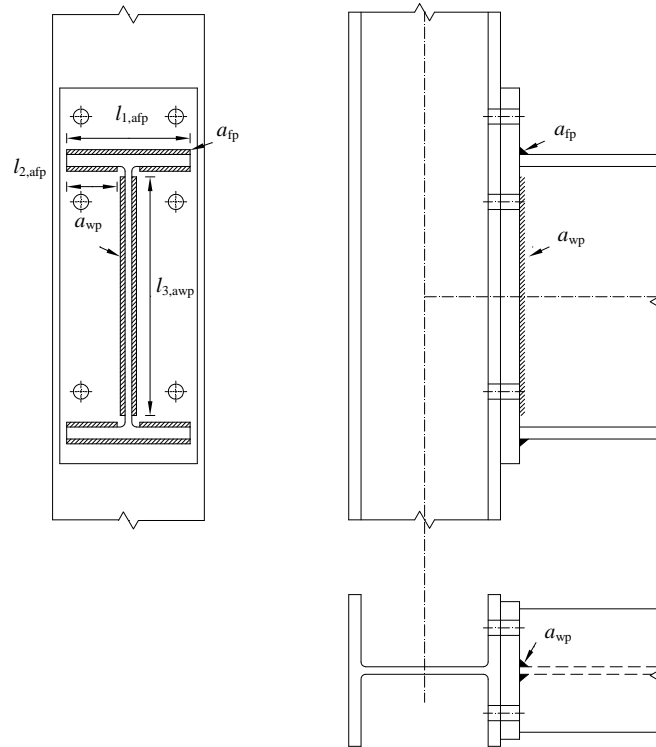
Soldaduras en una unión atornillada con chapa de testa extendida.
